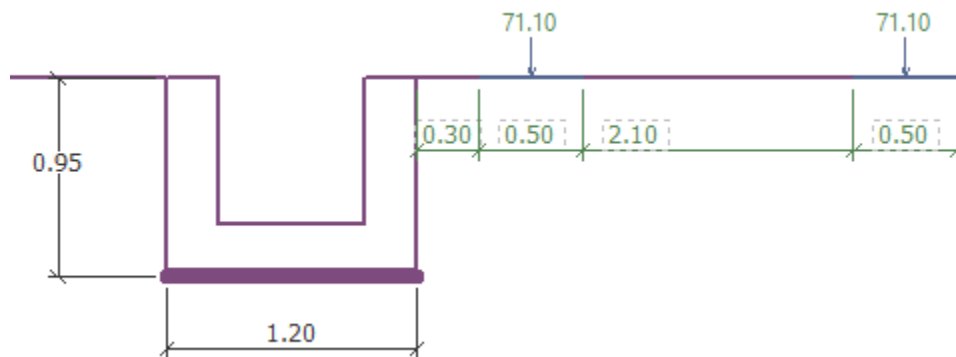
Sobrecargas del sistema, cuneta de mampostería.
